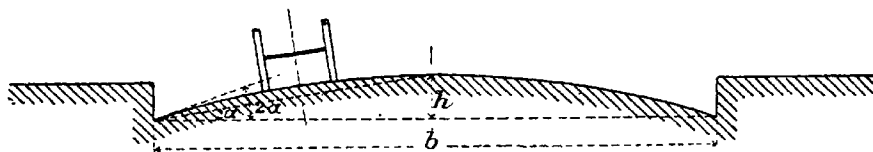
Dachförmige Bildung der Strassenoberfläche.
